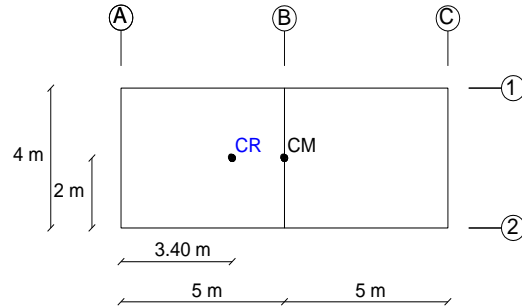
Centro de rigidez de la segunda planta de la superestructura
